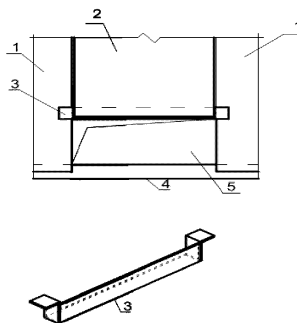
Вариант устройства проема в ПБФ: 1,2 – плита перекрытия; 3 – опорная конструкция; 4 – несущая стена; 5 – проем
